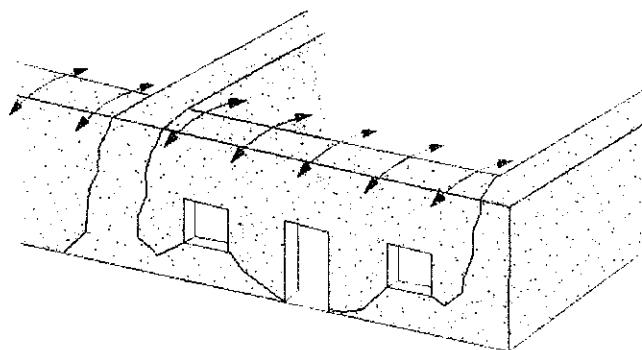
Fissuration par flexion hors plan d'un mur bien contreventé latéralement
